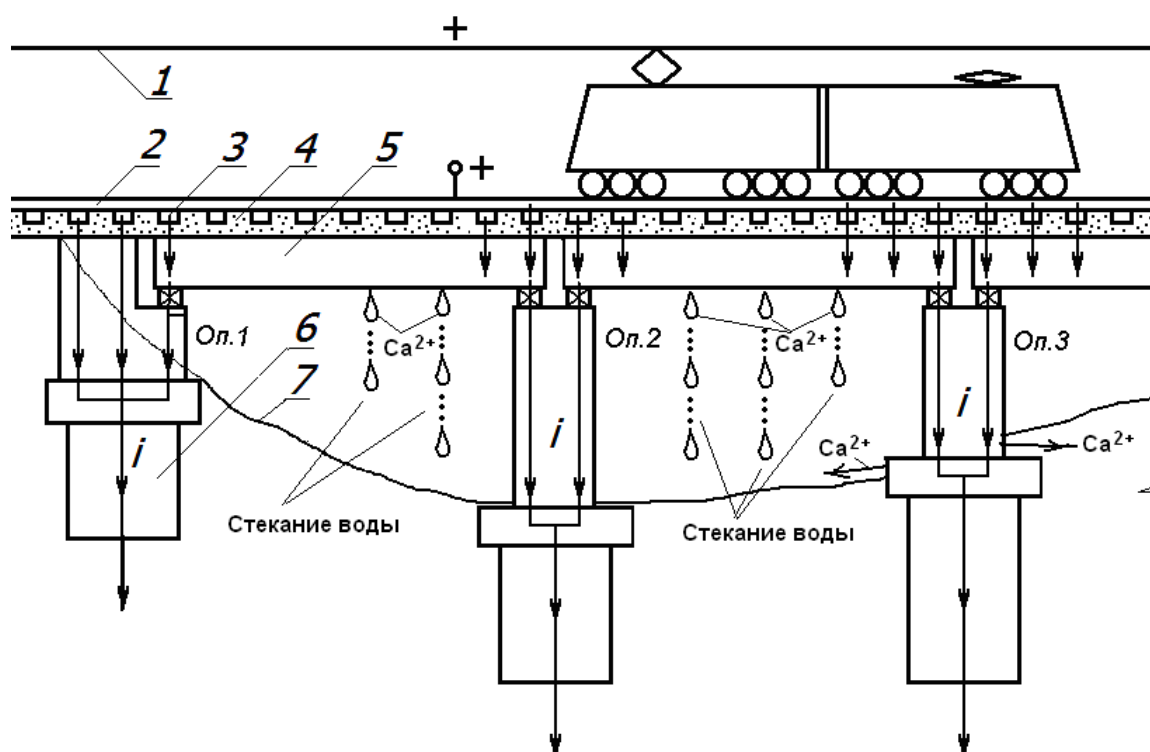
Схема протекания токов утечки по конструкциям железобетонного моста:
